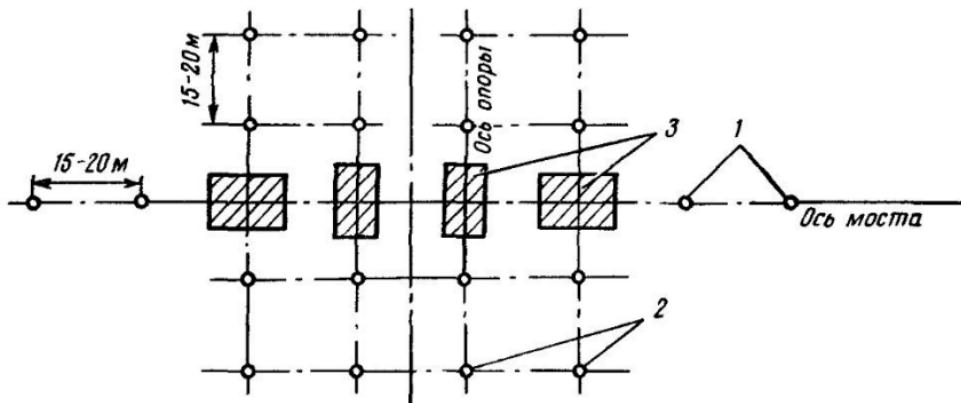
Схема разбивки фундаментов опор малого моста:
